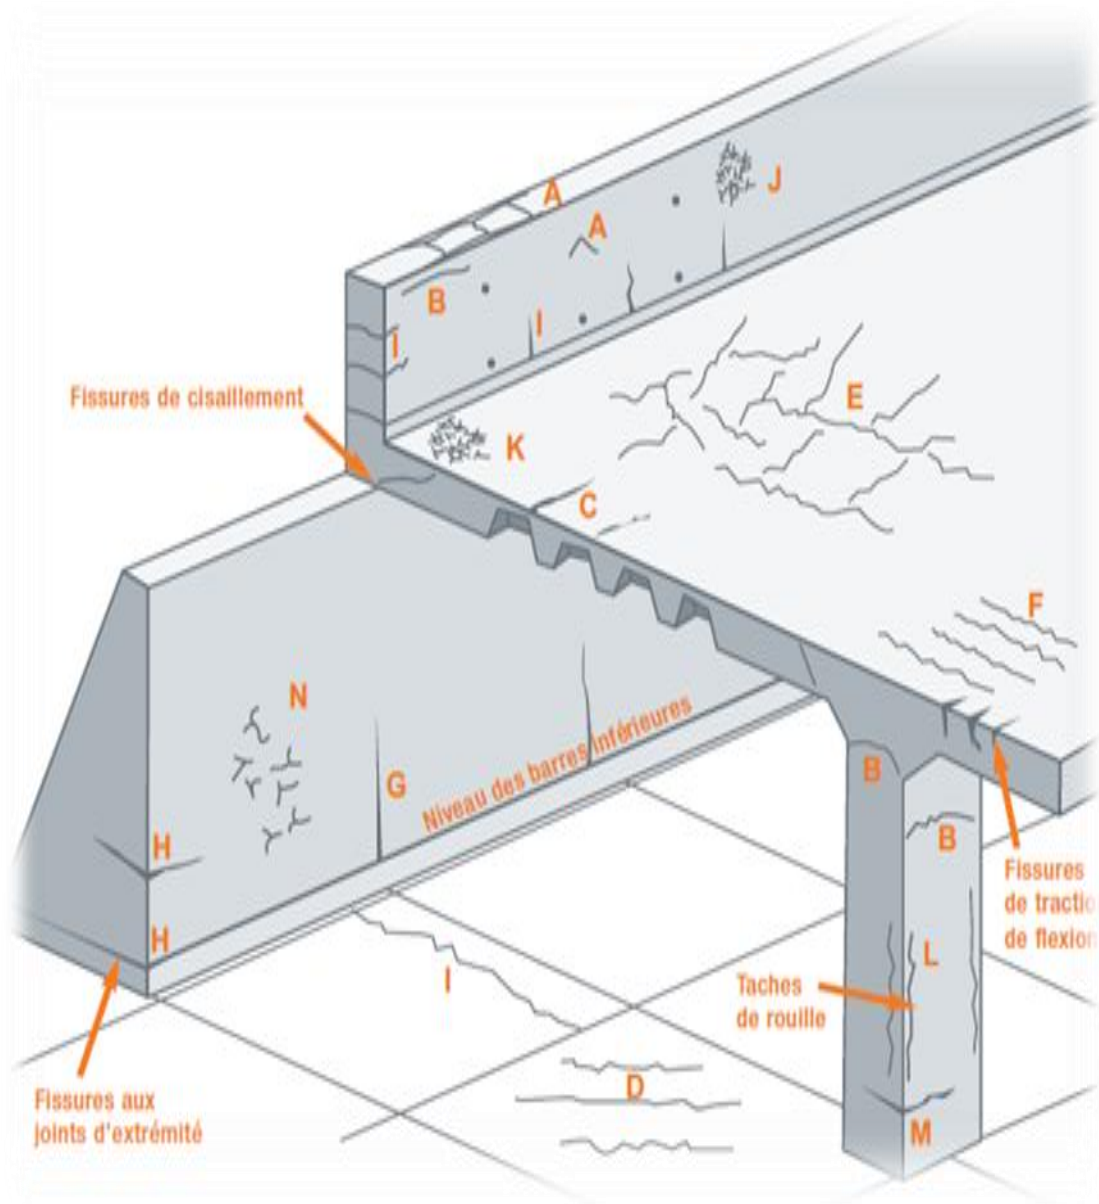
Emplacement de différents types des fissures sur un ouvrage en béton.
